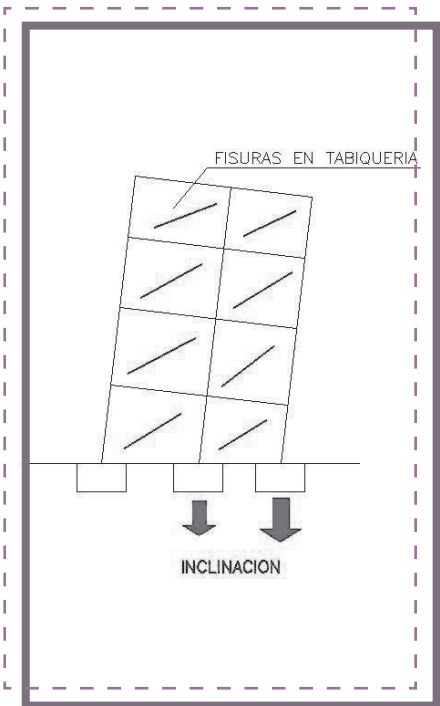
Esquema de fisuras por inclinación del edificio.
